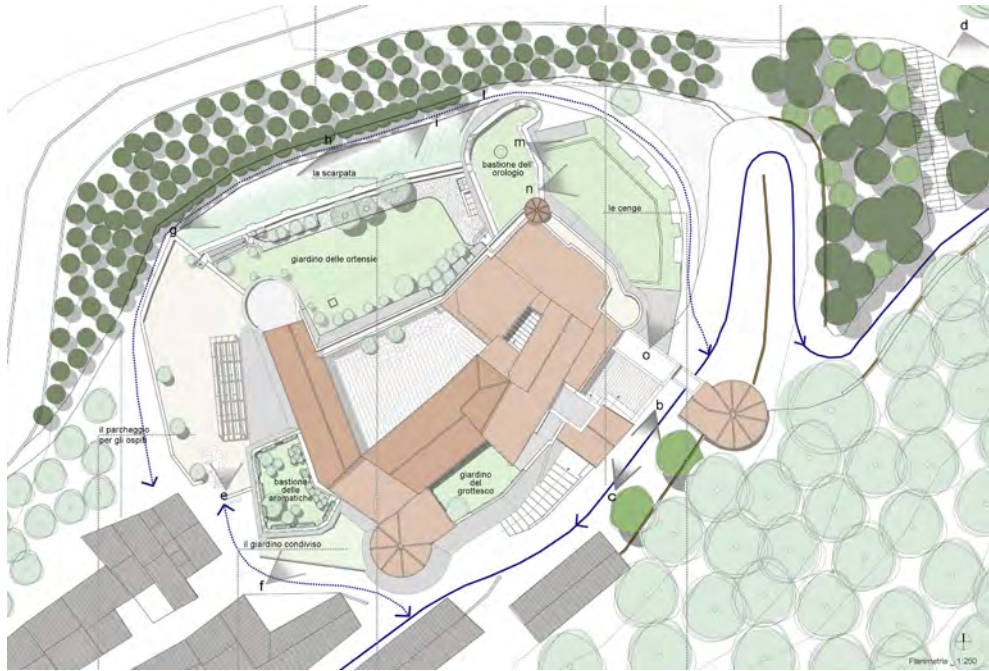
Planimetria del castello. Estratto dalle tavole di Tesi (tav.4)
